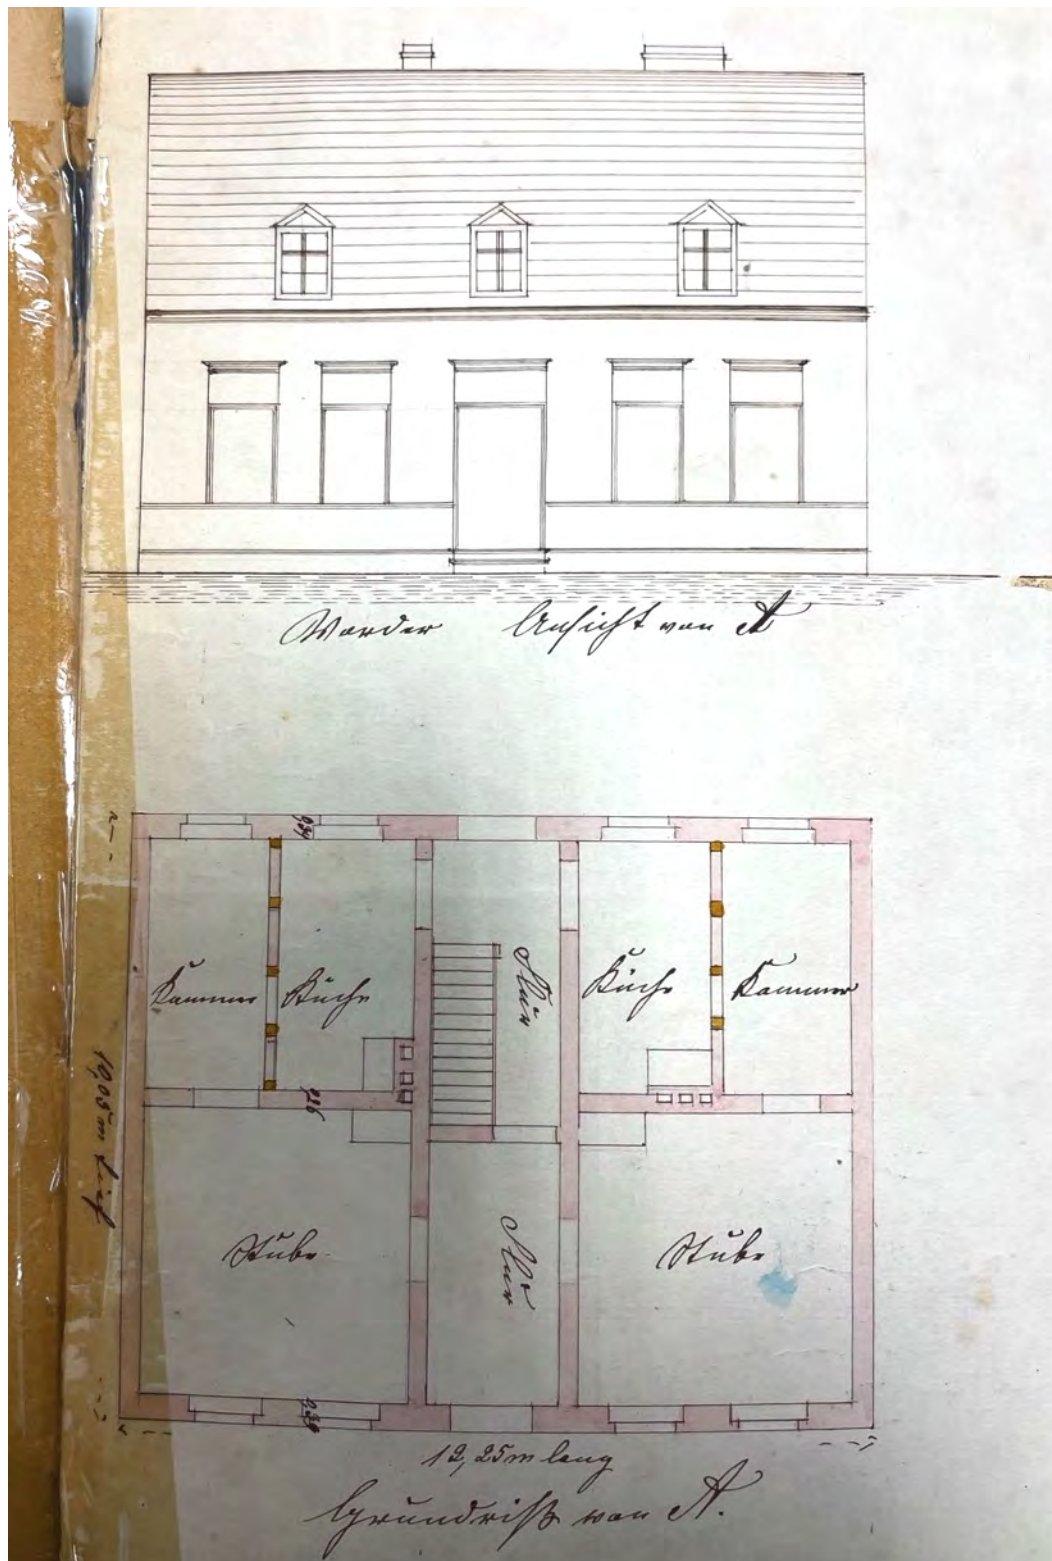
bauzeitlicher Plan zum Wohnhaus – Ansicht, Grundriß EG
